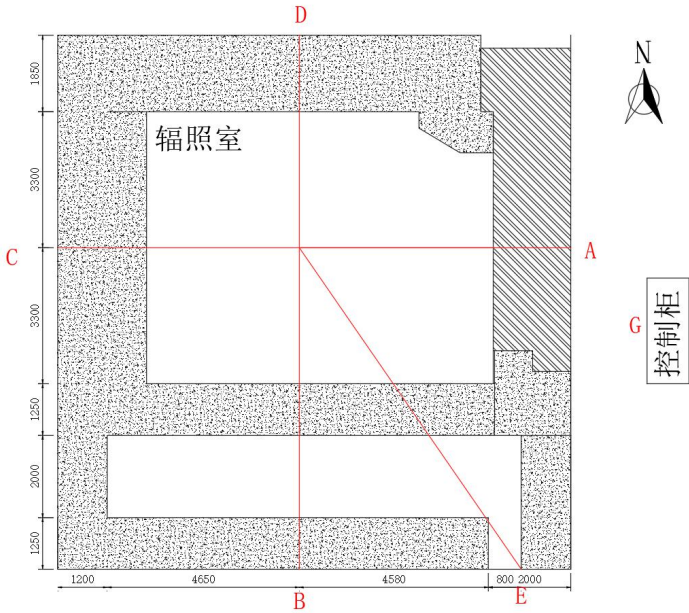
辐照室屏蔽结构平面图 (尺寸单位: mm)
